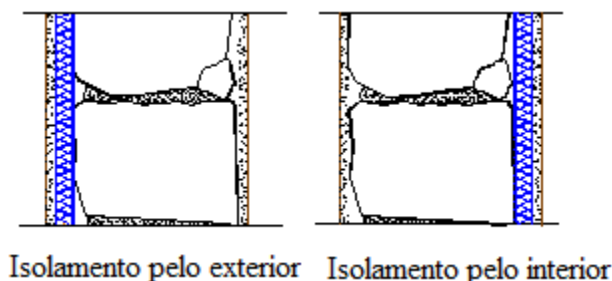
Localização do isolamento de paredes exteriores em pedra
